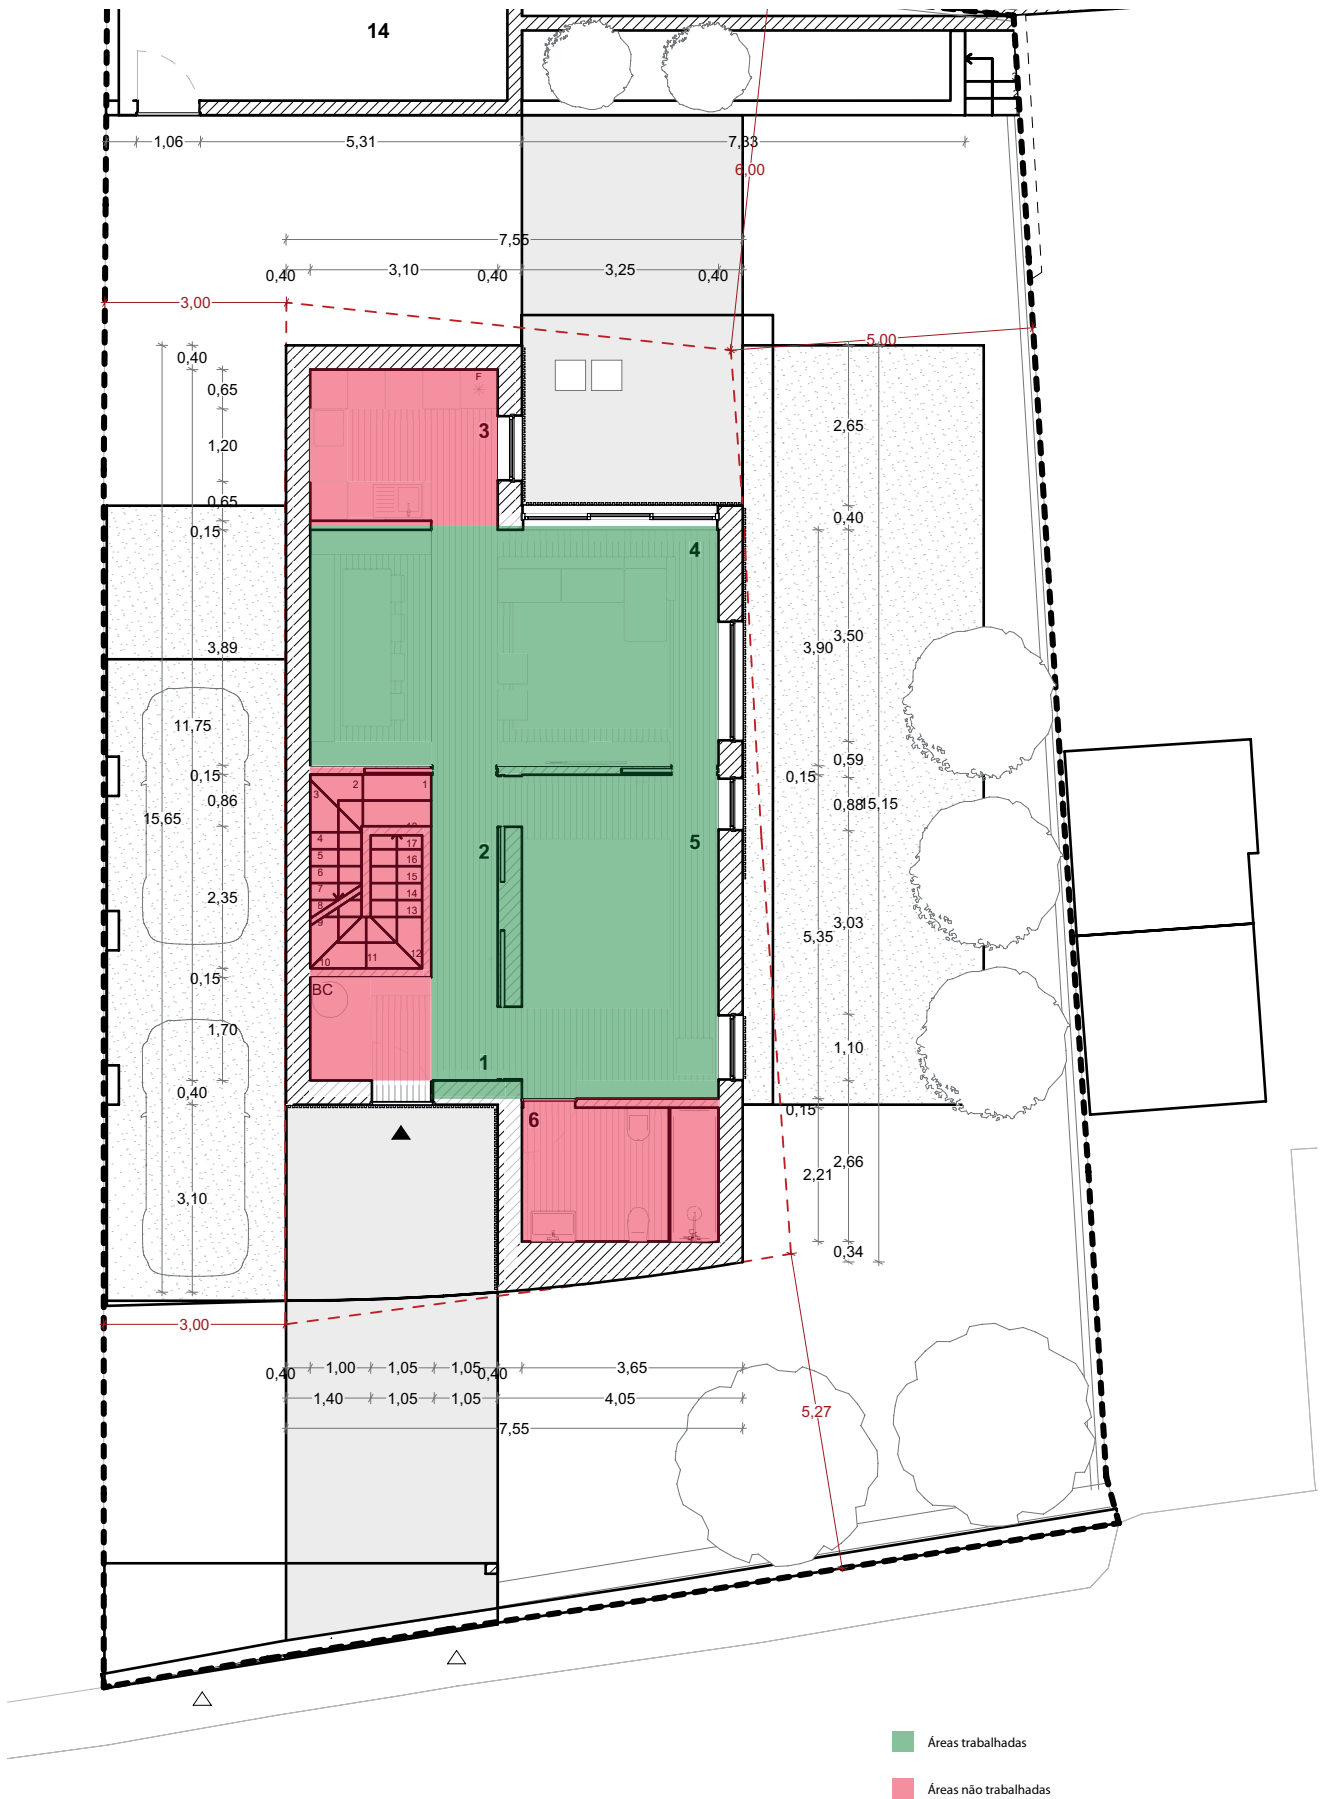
Planta rés/chão, áreas trabalhadas e não trabalhadas.
